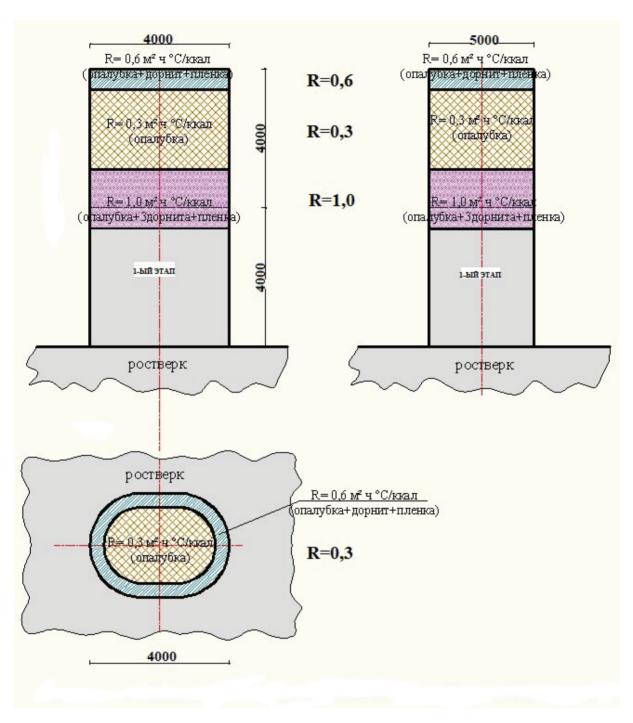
Схема разбивки стойки опоры Крымского моста на блоки бетонирования и её укрытия дополнительной тепловой изоляцией
